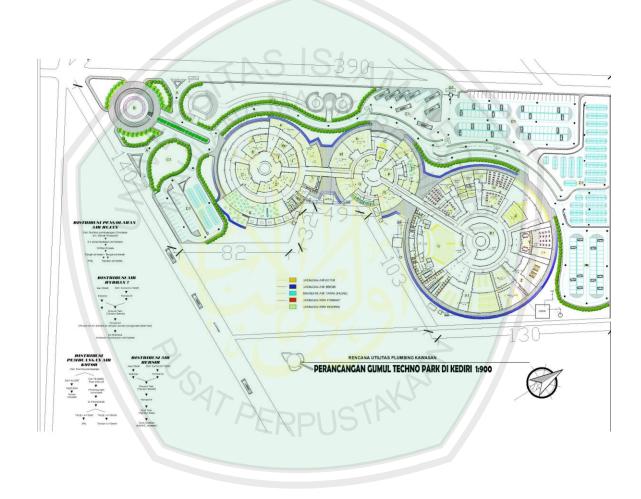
Tampilan Bangunan Gumul Techno Park
